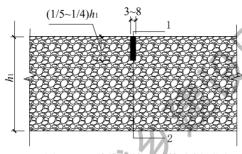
缩缝处施工缝构造剖面图 1-填缝胶, 2-施工缝
